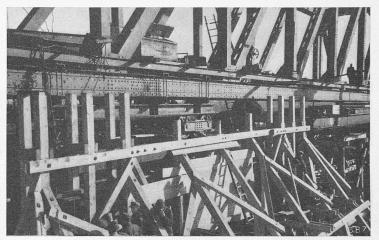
Oberer Teil des Schiffsgerüstes mit Führungshölzern und festen Verschubrollen, darüber MAN-Träger
